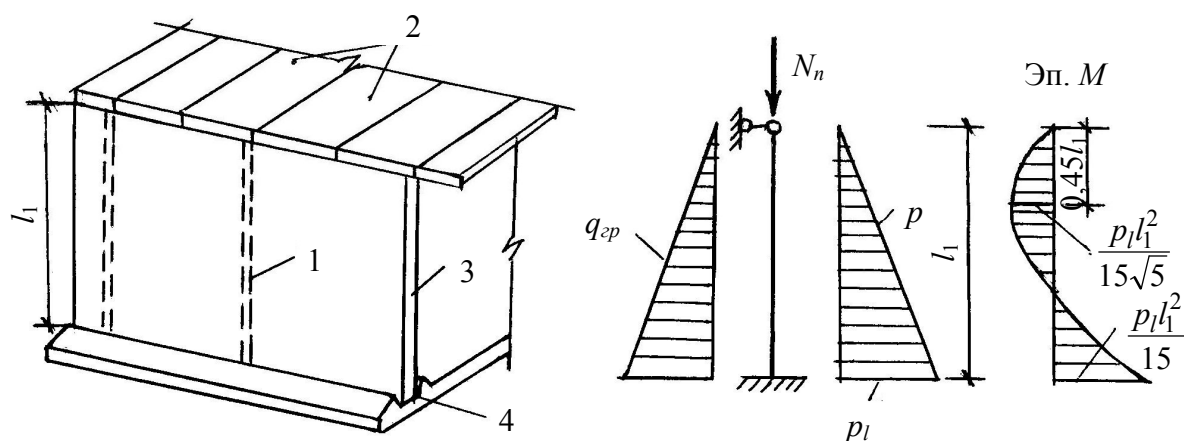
Расчет стены прямоугольного резервуара, работающего по балочной схеме:
